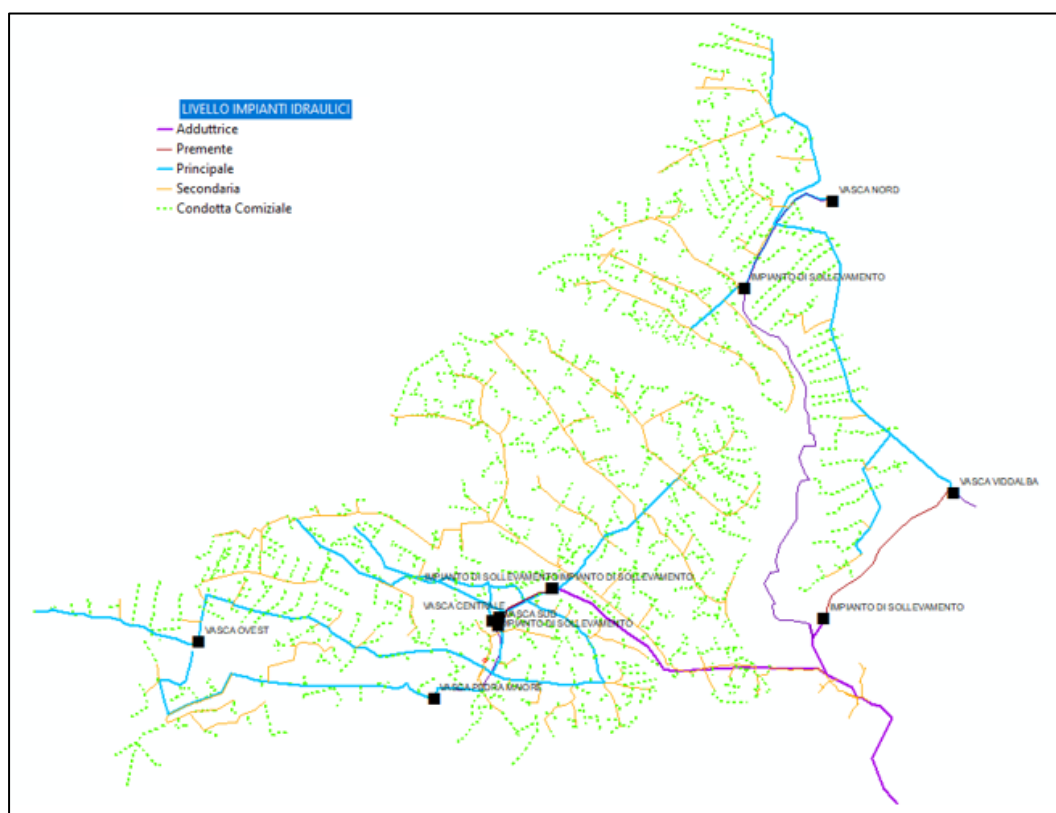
Planimetria generale della rete e degli impianti idraulici del distretto irriguo della Bassa Valle del Coghinas.
